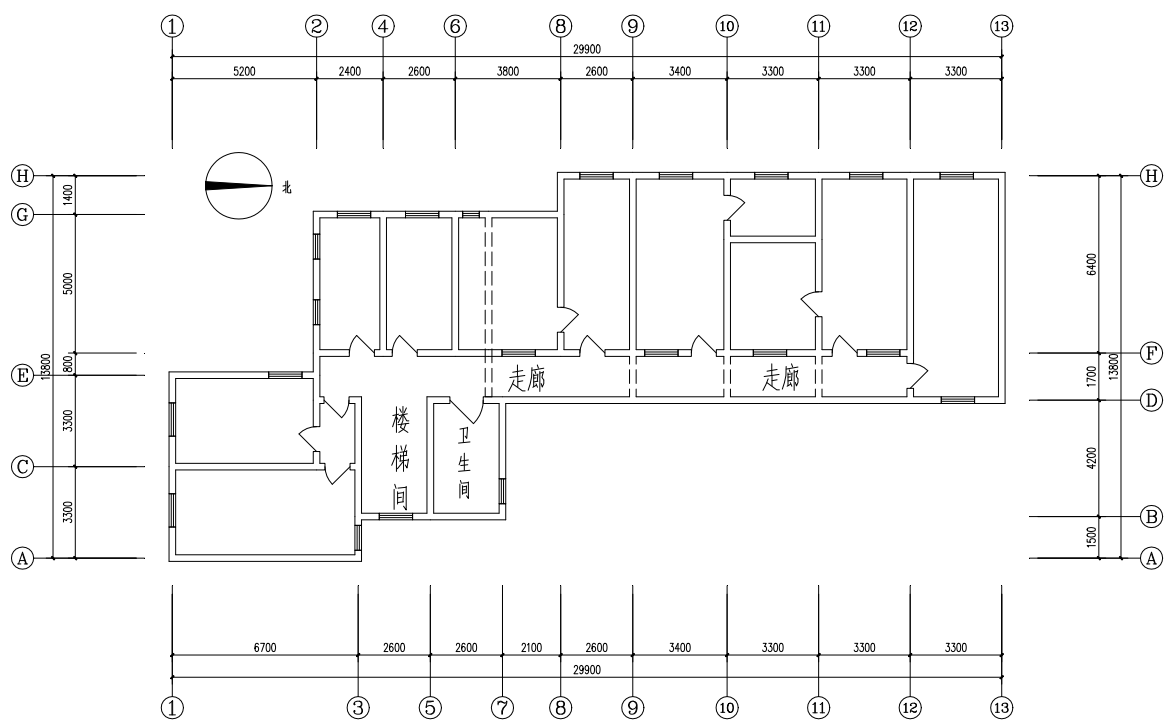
台东一路 32 号住宅楼标准层平面布置示意图
